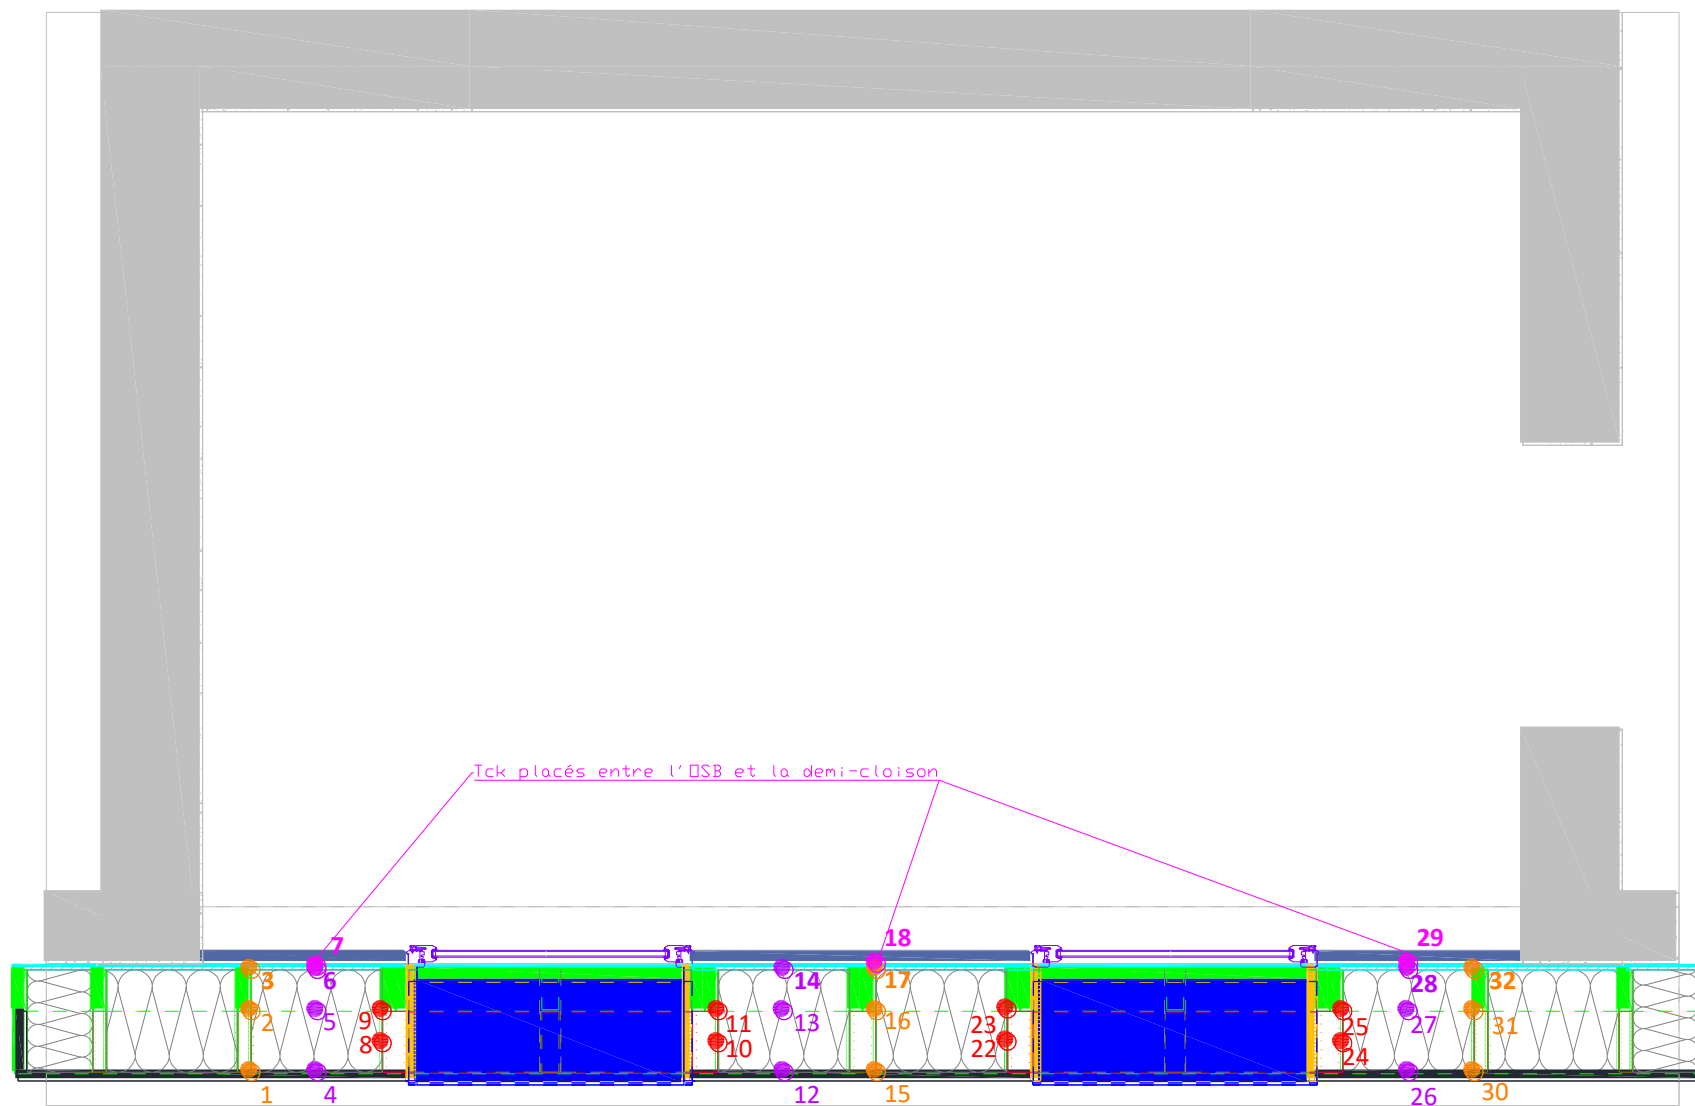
Instrumentation de l'élément de façade - Coupe II-II
